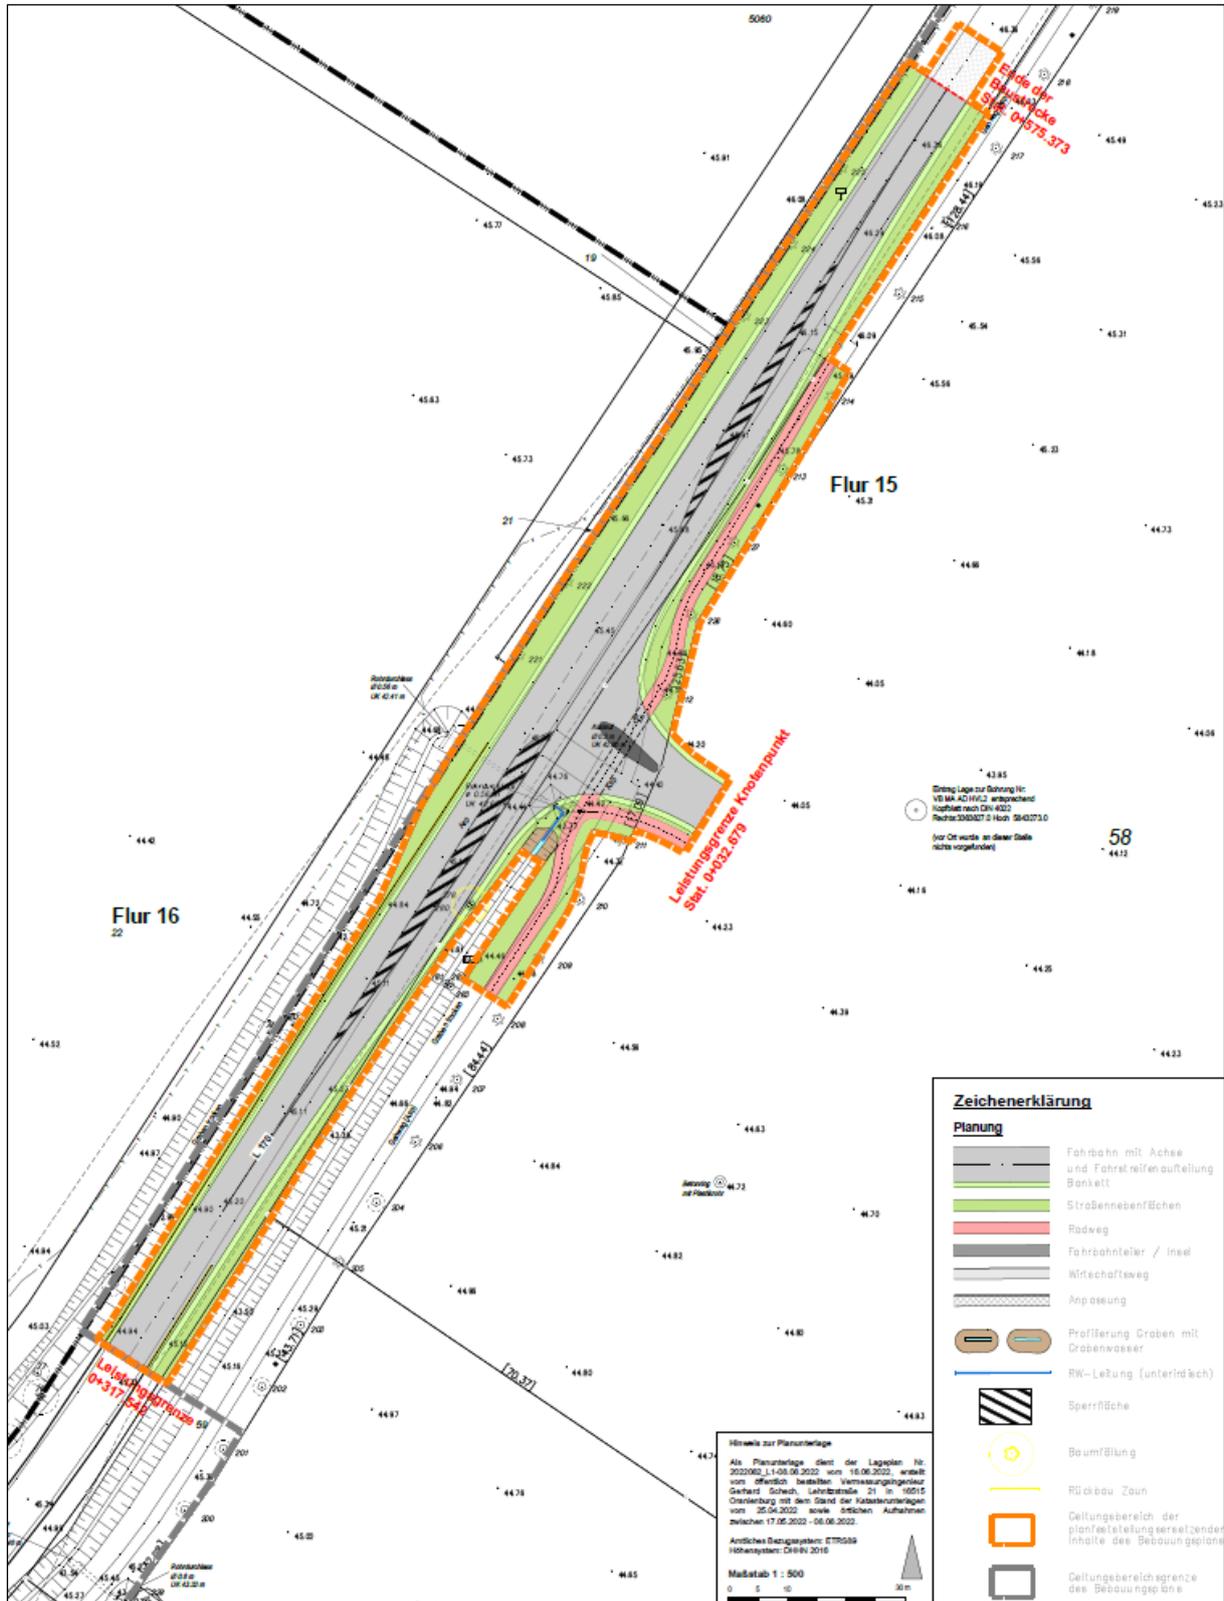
Ausschnitt Planzeichnung Teil B – planfeststellungersetzende Inhalte des Bebauungsplans
